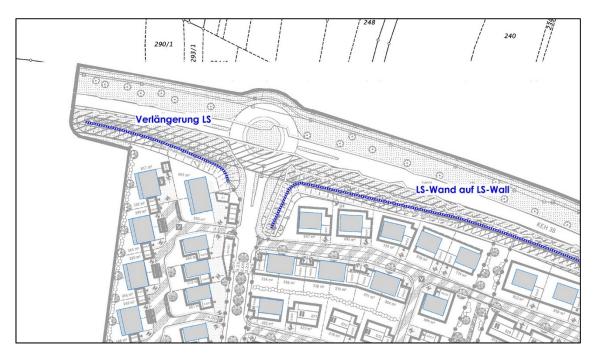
Lageplan mit Darstellung der Lärmschutzanlagen entlang der Kreisstraße KEH 38
